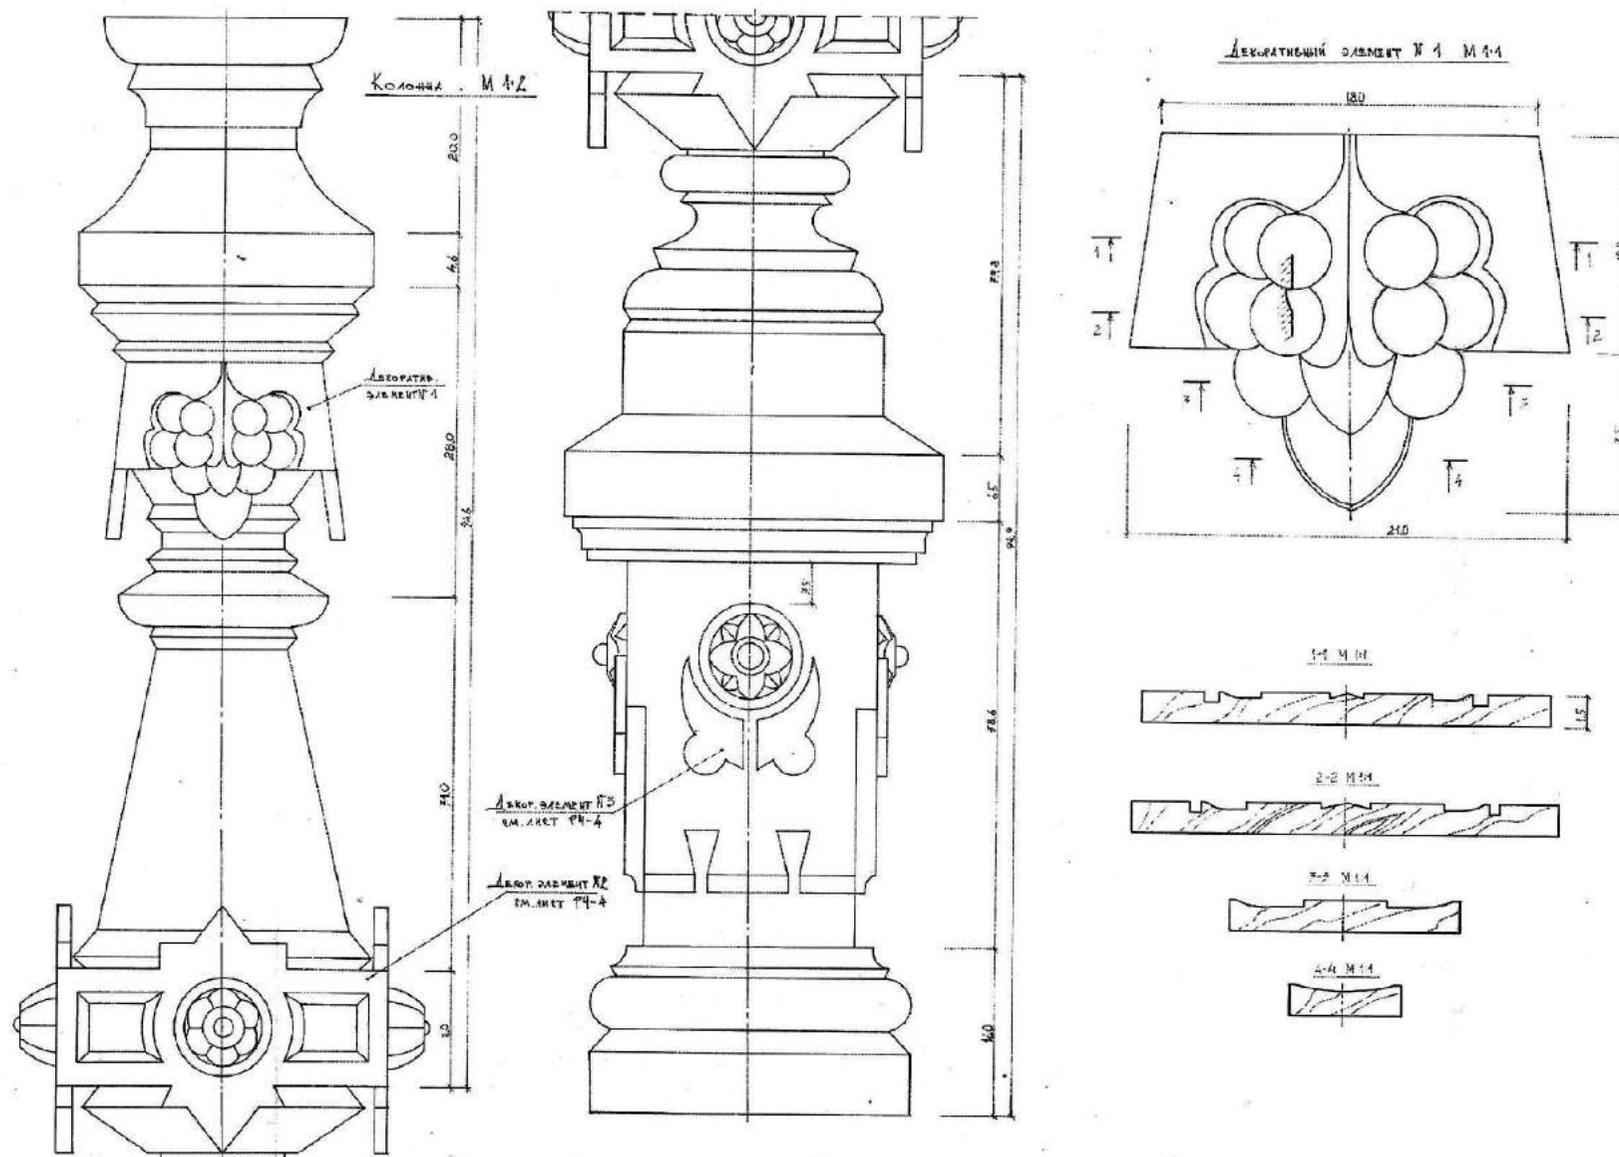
Столб крыльца северного фасада. Фасад, резные накладные детали
